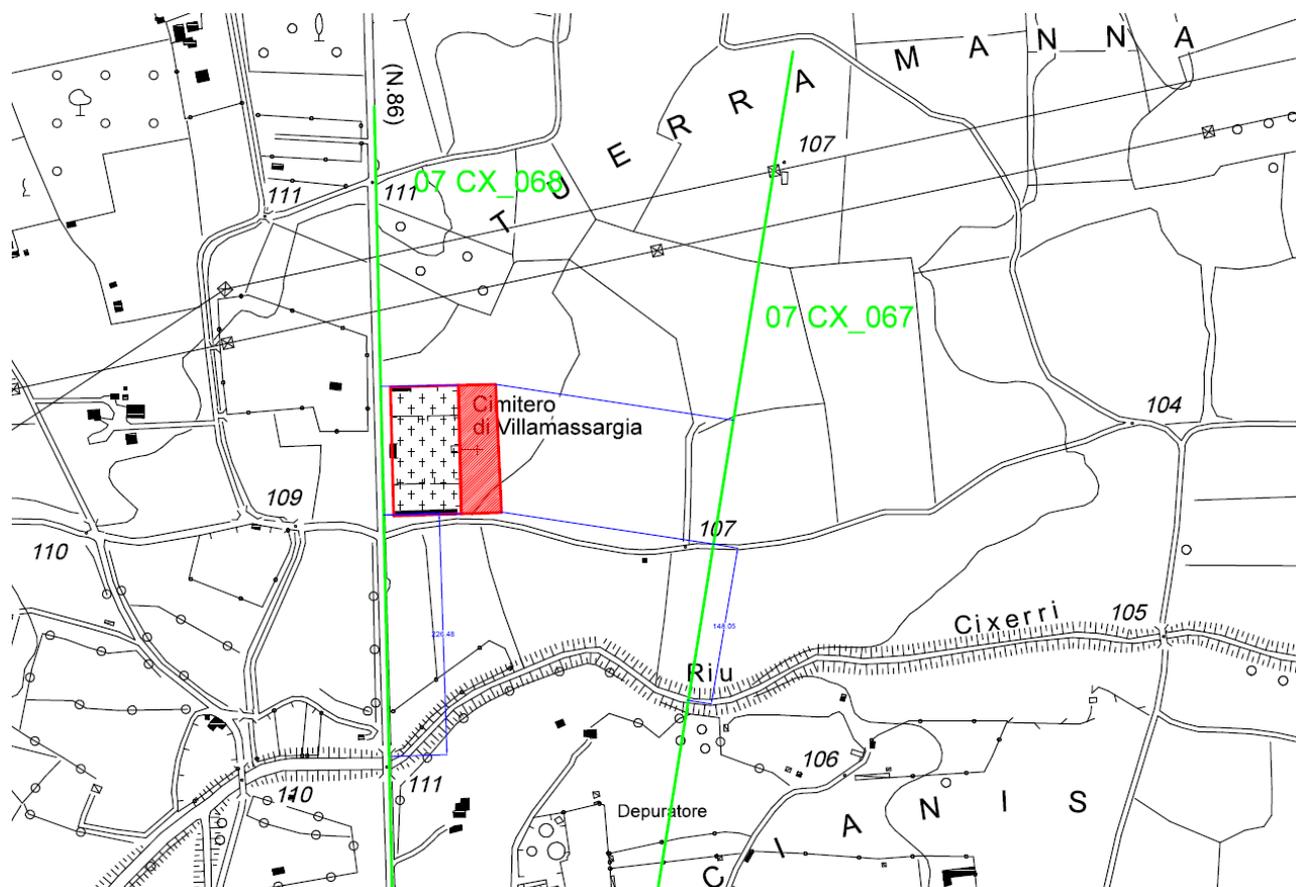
Planimetria con l'indicazione delle opere previste e la pericolosità idraulica vigente
